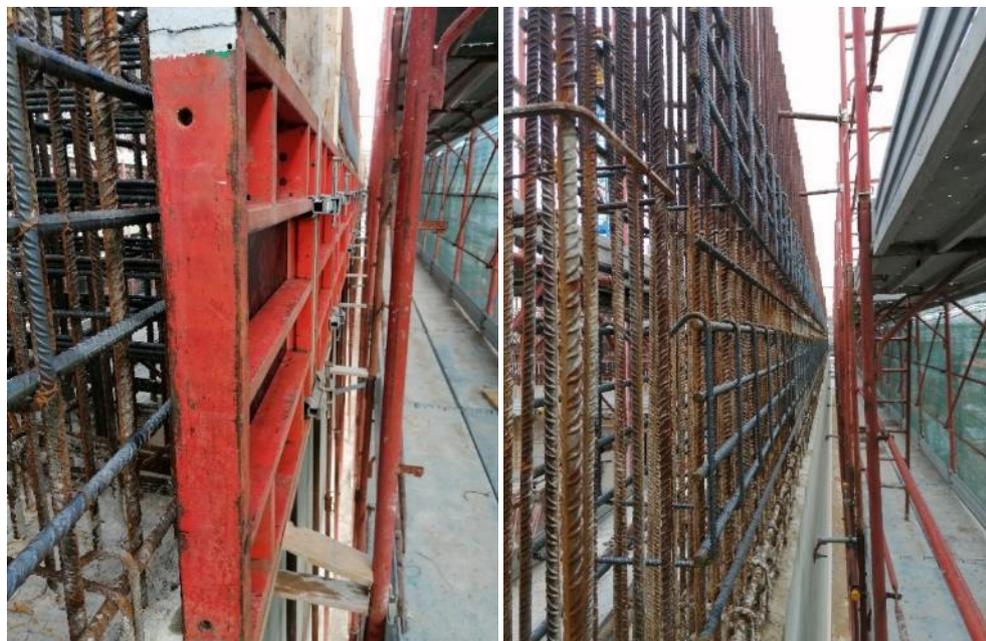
Foto di cantiere particolare armatura e casseri delle strutture in elevazione
